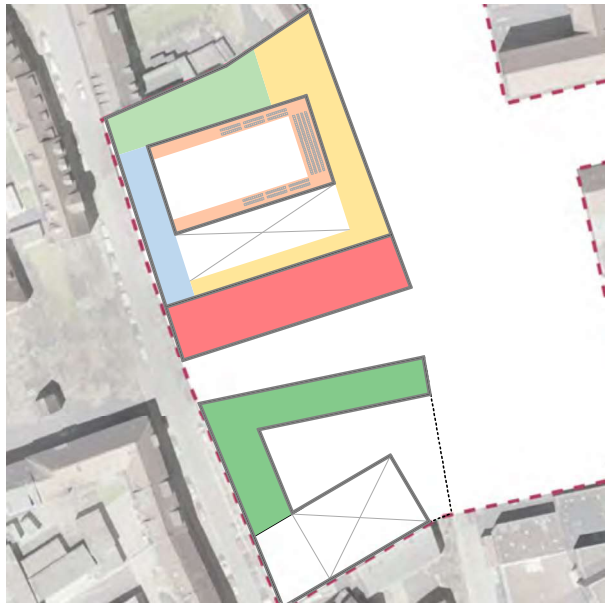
Grundriss OG1 Großer Hof V1
